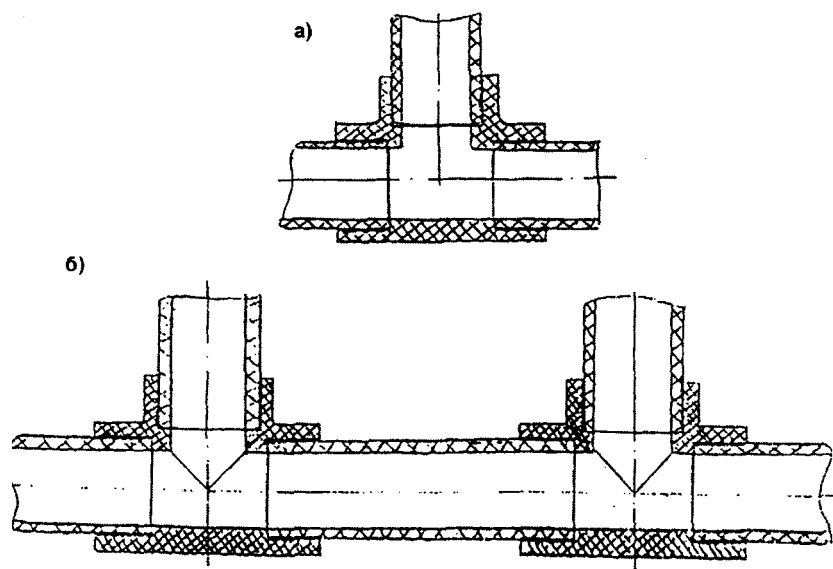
а - Сварка нагретым инструментом впаструб тройника равнопроходного раструбного;
